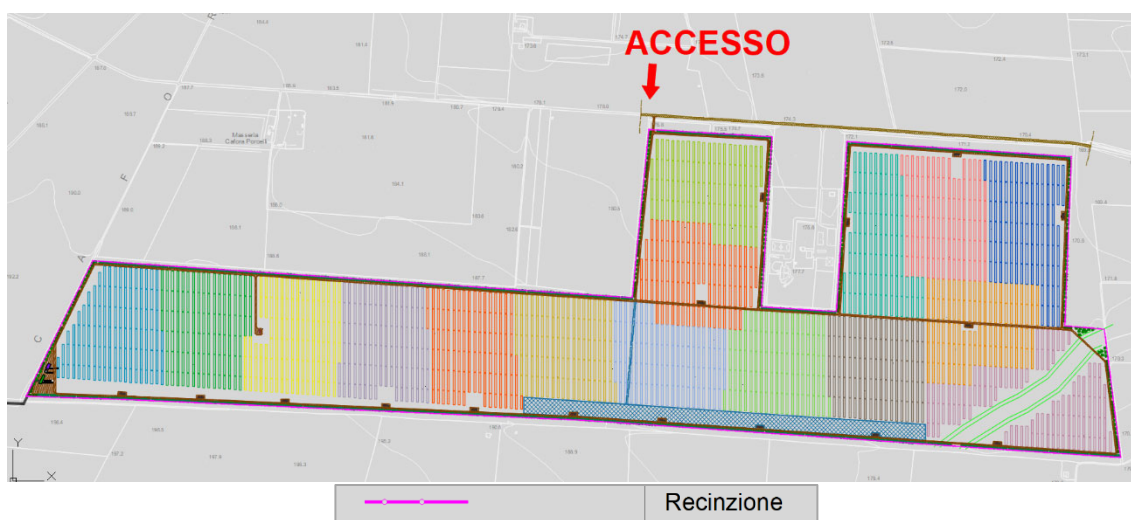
Individuazione dell'area di impianto con indicazione dell'ubicazione del nuovo ingresso all'impianto
